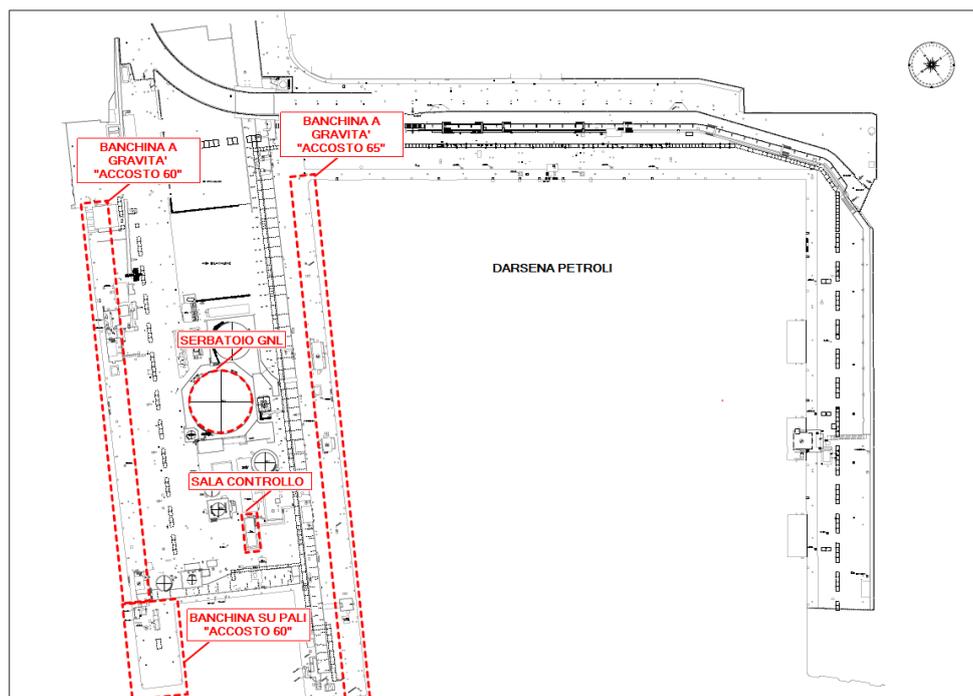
Principali Strutture Oggetto di Intervento nel Sito di Progetto
